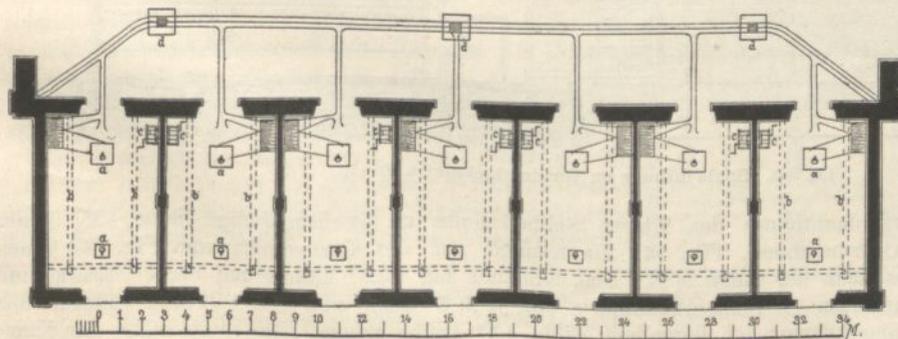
Grundriss einer Reihe Schlachtkammern.
